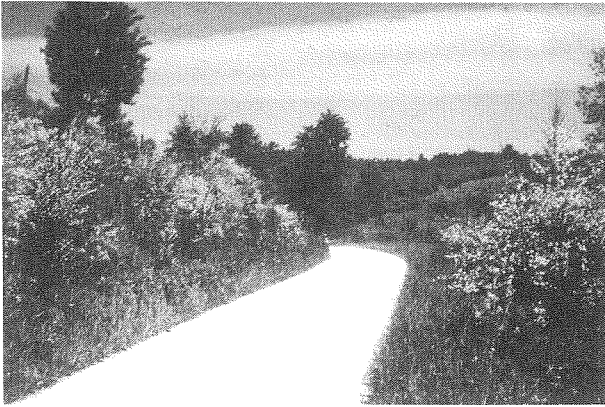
„Strehlke Waldstraße“, Betonausbau 1956. Aufn. 1960.
